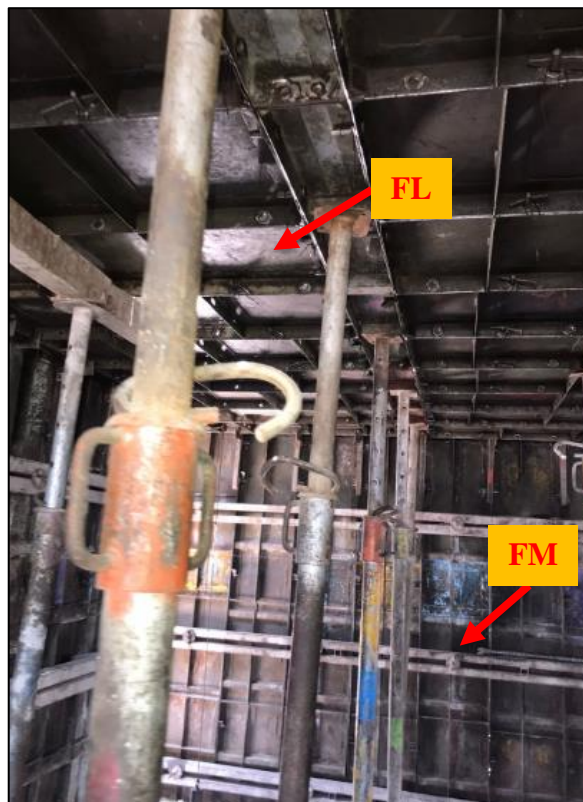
Formaleta de Muro (FM) y Formaleta de Losa (FL) Fuente: Edificaci3n del Proyecto 01
